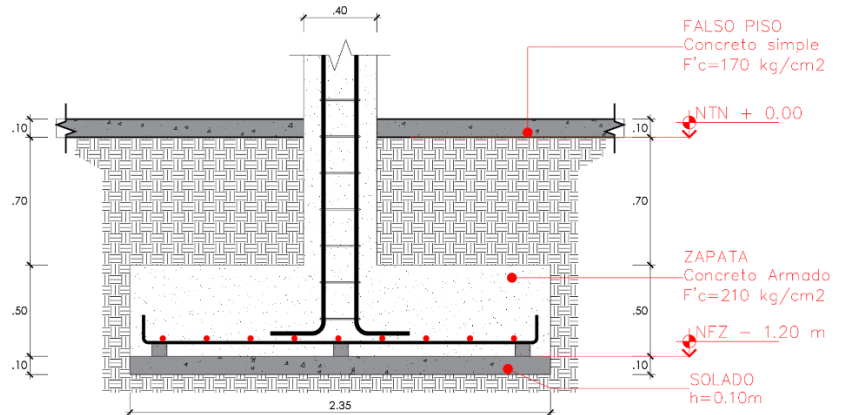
Detalle de zapata (suelo natural) - Corte Z1.
